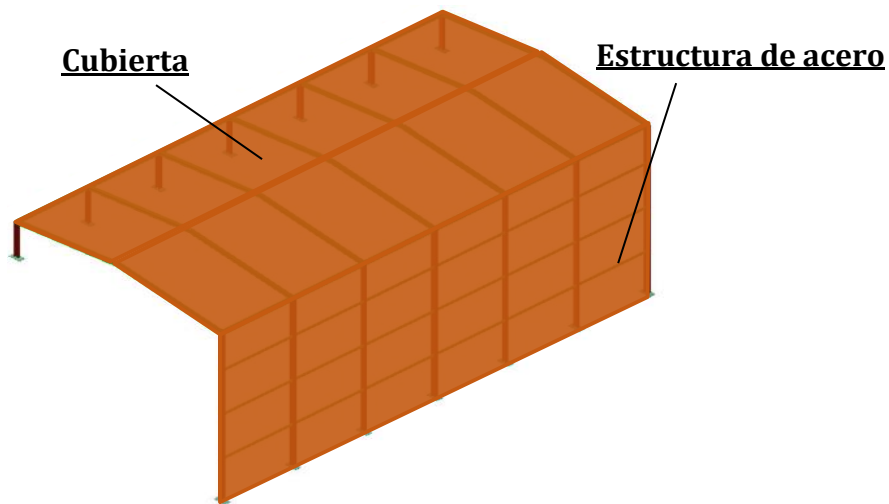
Fase 2 del frontón cubierto con pared de muro
